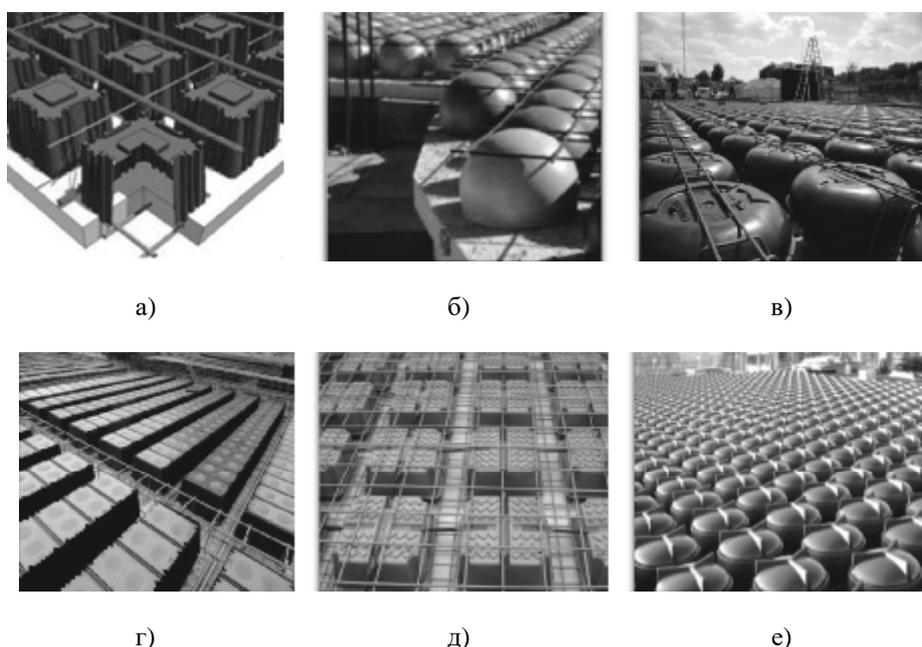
Виды монолитных железобетонных перекрытий с неизвлекаемыми пустотообразователями: а – Airdeck; б – BubbleDeck; в – Cobiax; г – U-BahnBeton; д – U-BootBeton; е – Beeplate
